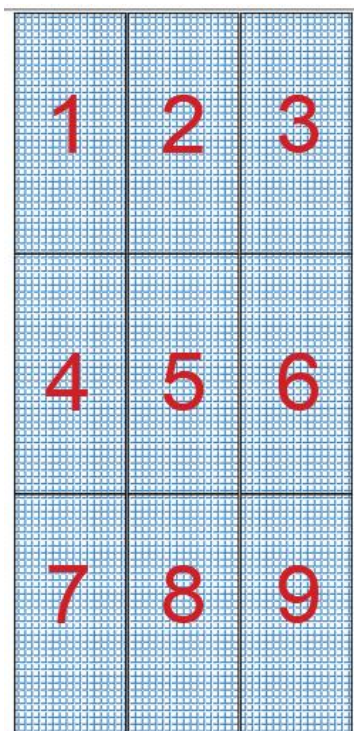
Máximo de paneles a instalar en cubierta. Fuente: Autores.
